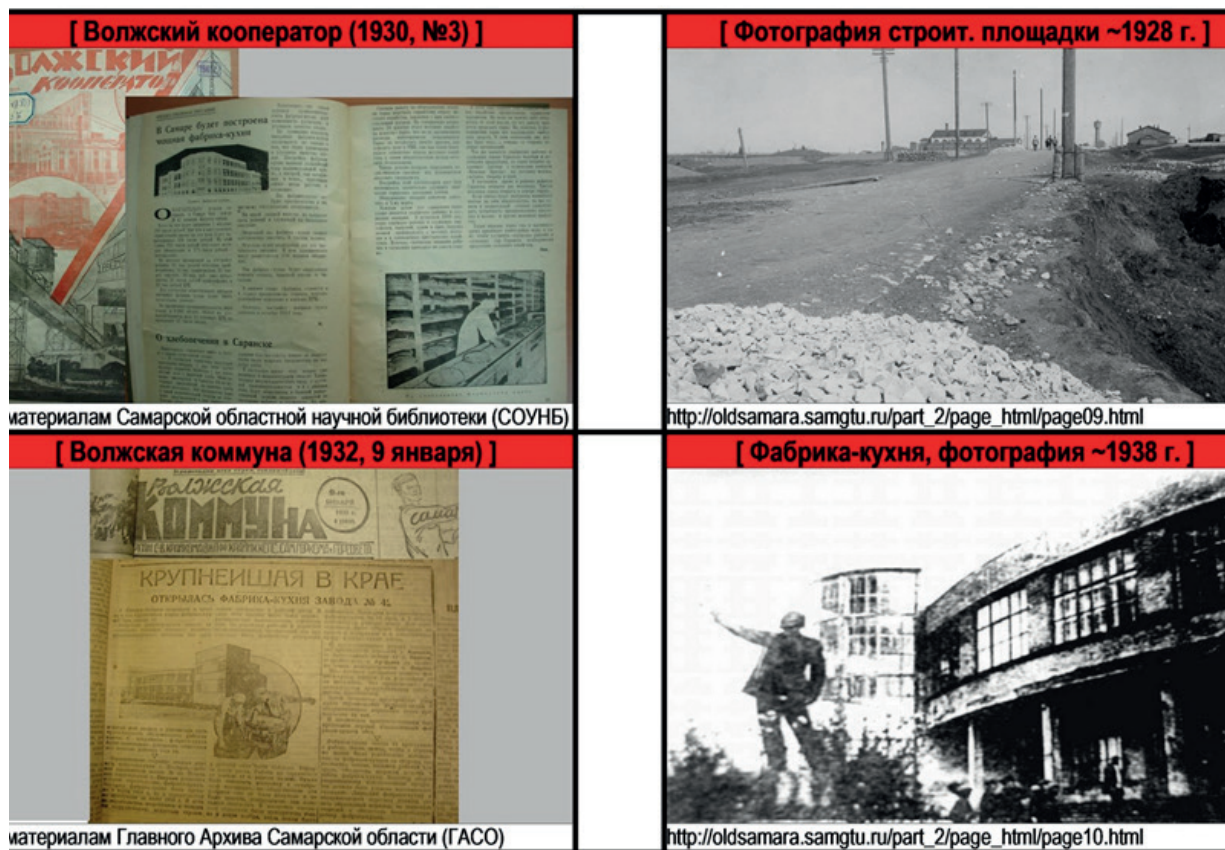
Архивные фото газет и строительной площадки фабрики-кухни в Самаре
